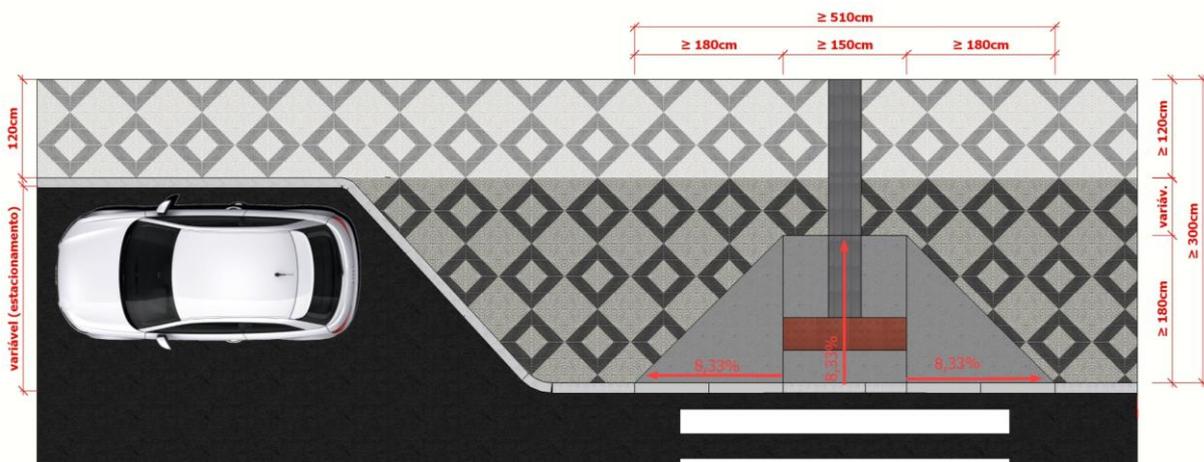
Rebaixamento Calçadas para meio-fio 10 cm
